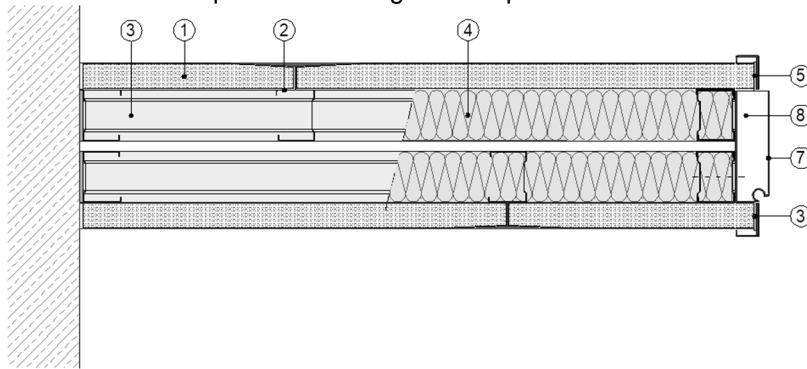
Tabique Pladur® Magna de separación alternado.
